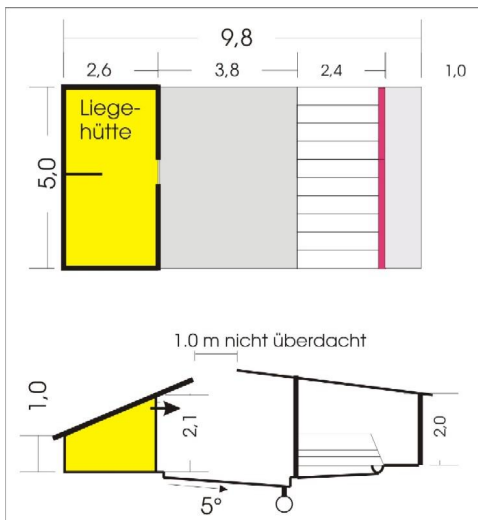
Grundriss und Ansicht einer Bucht für 10 tragende Sauen
